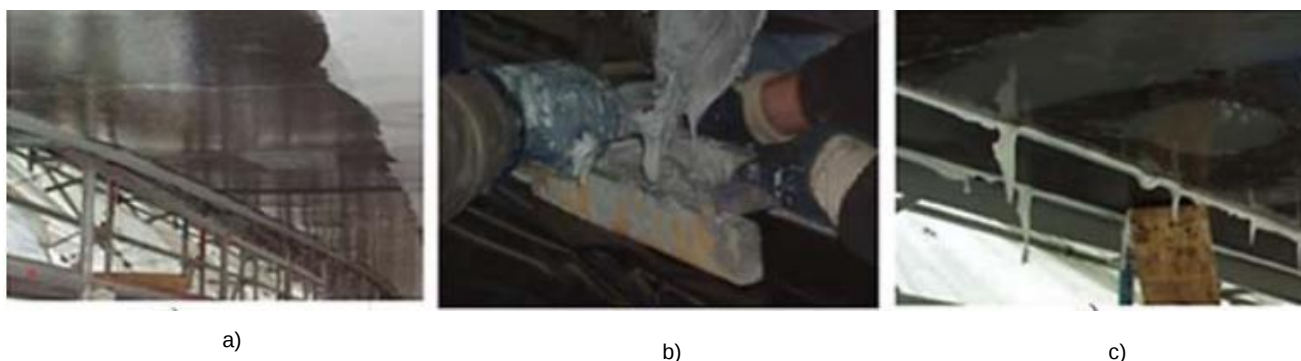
Procedimentos da colocação dos laminados na zona central do meio vão a) colocação do epóxi, b) colocação da argamassa de base epóxi de colagem sobre laminado, c) colocação do laminado na face superior da laje inferior (Branco, 2014).
